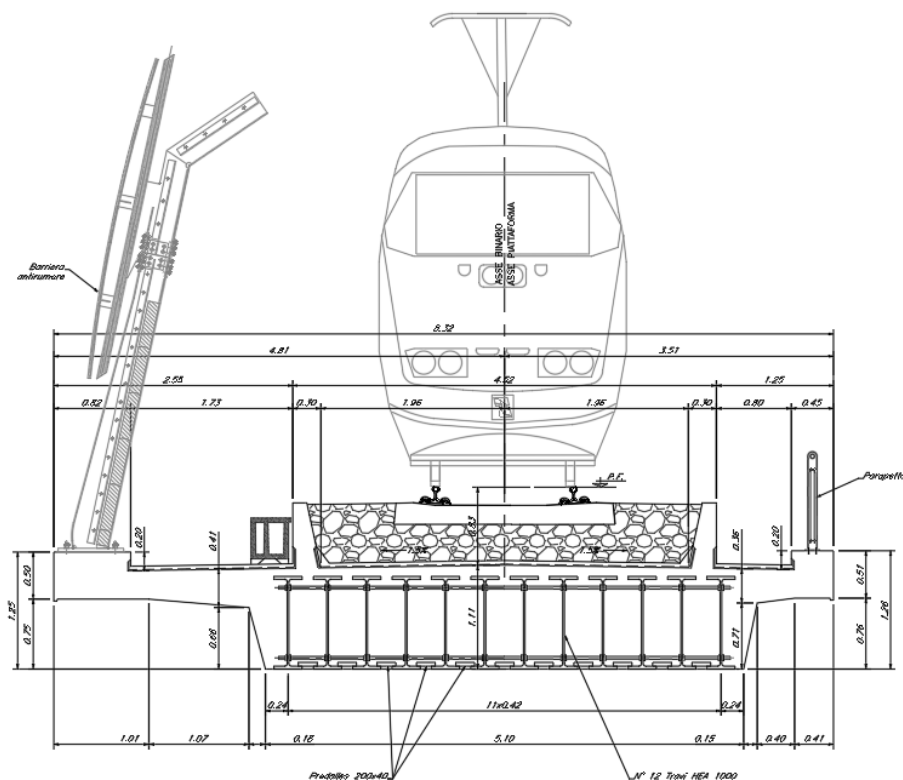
Sezione Trasversale Impalcato a travi incorporate
